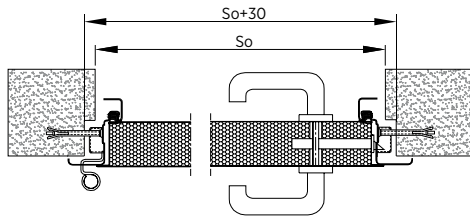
Montage einflügeliger Türen mit Eckzarge an der Mauer - Horizontalschnitt
